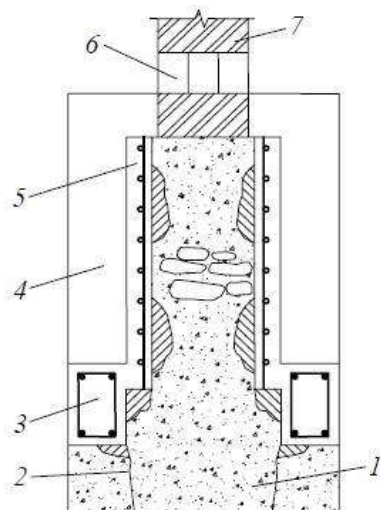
Вариант усиления кладки ленточного фундамента: 1 – фундамента; 2 – трещины в ступенях; 3 – продольная балка на ступени; 4 – контрфорс; 5 – рубашка; 6 – рандбалки; 7 – стена здания
